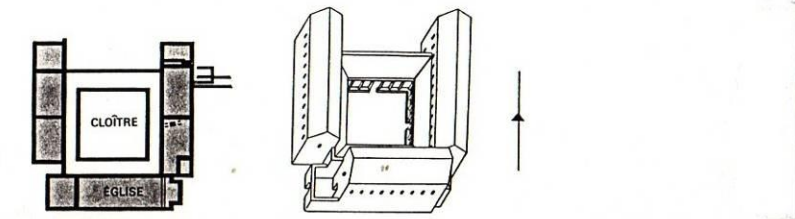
/128.a. A ET B - LORSCH, PREMIERE ABBAYE : PLAN ET ÉLEVATION.
